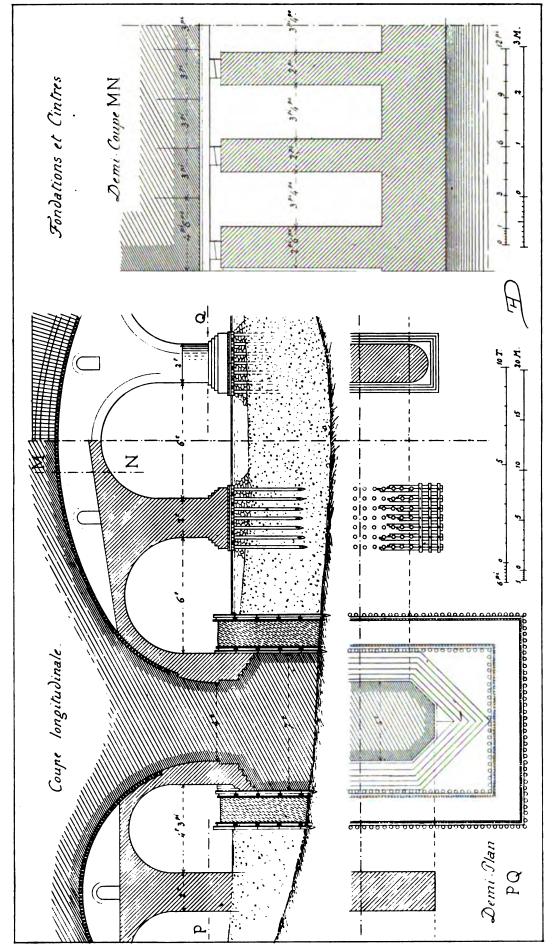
Pont de Gignac. - Fondations et Cintres.
